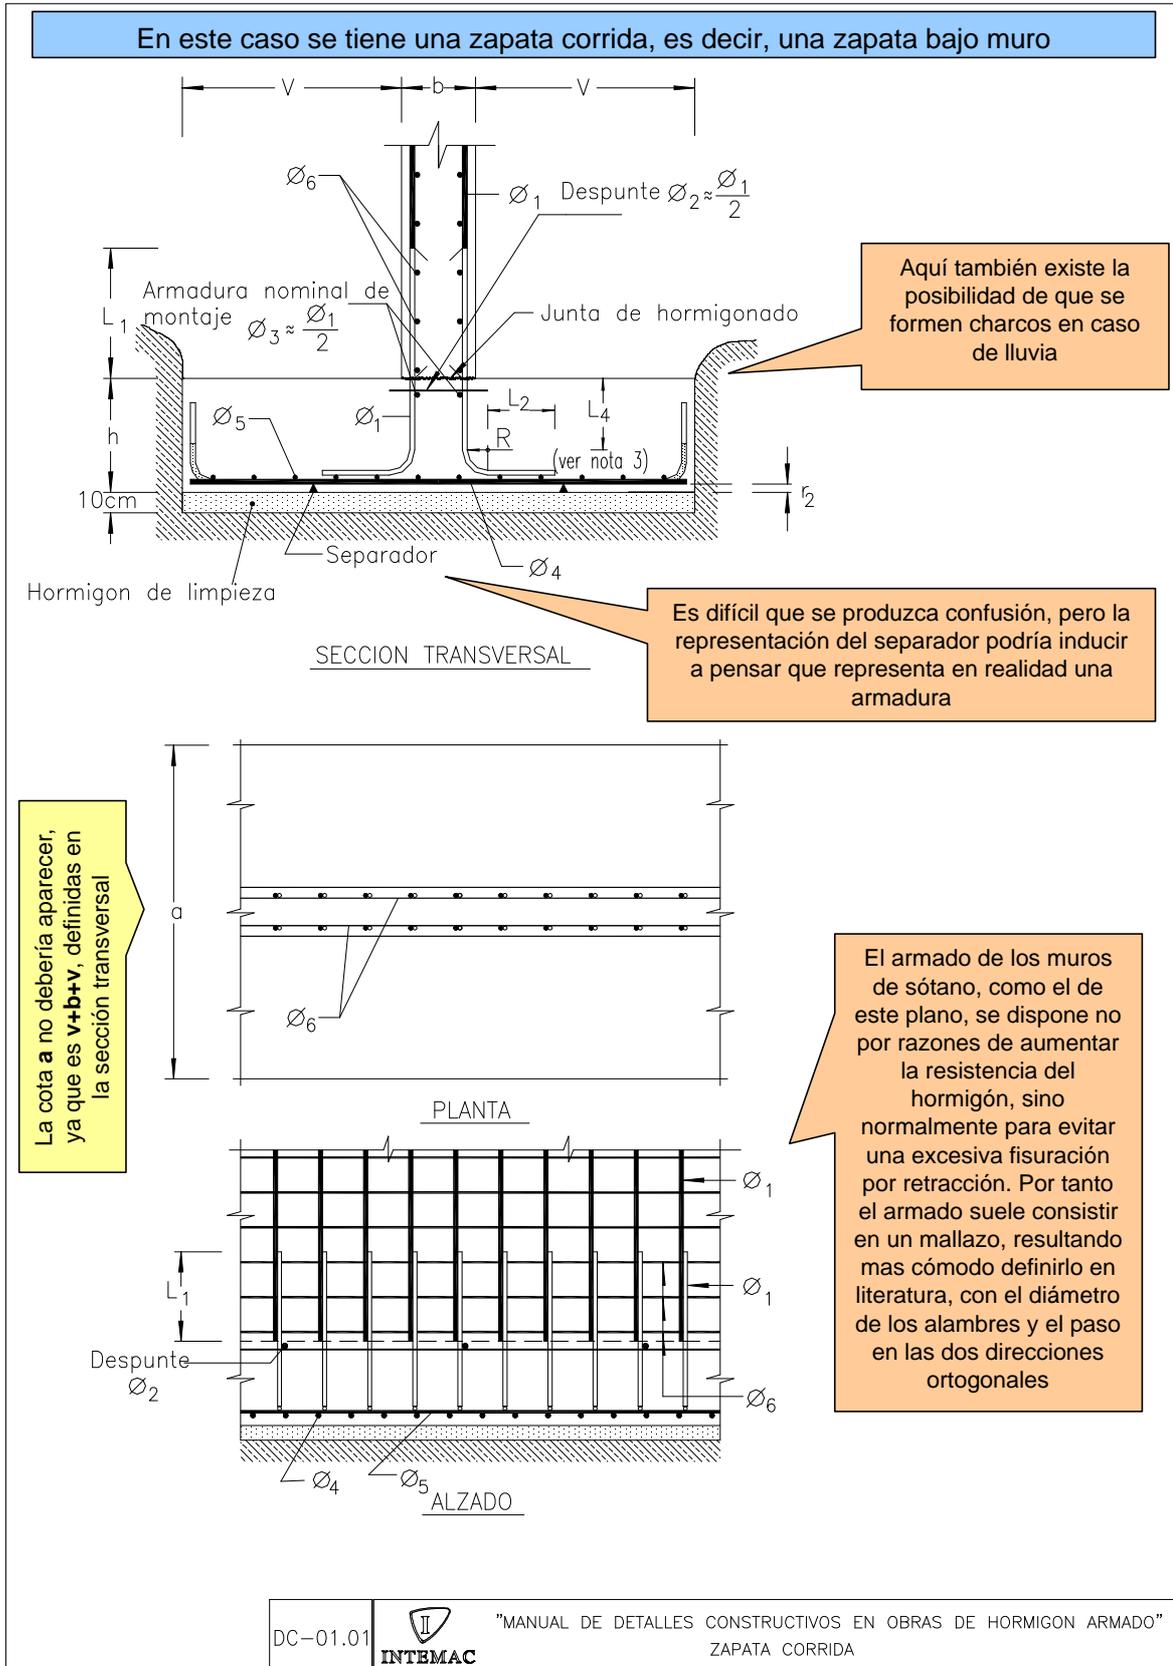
Zapata corrida soportando un muro de hormigón armado
